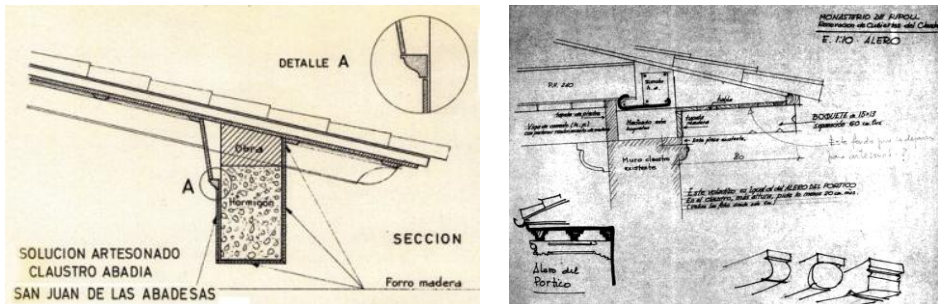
AAFV. Detalles constructivos incluidos en planos de proyecto. Soluciones de apoyo de cubierta y aleros. Iglesia de San Juan de las Abadesas y Claustro del Monasterio de Ripoll
